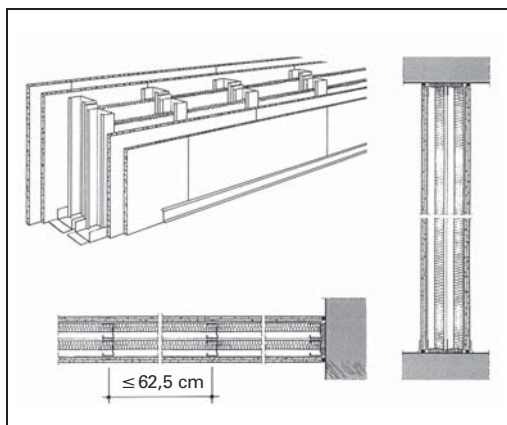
Metallständerwand als Doppelständerwerk, zweifach beplankt
